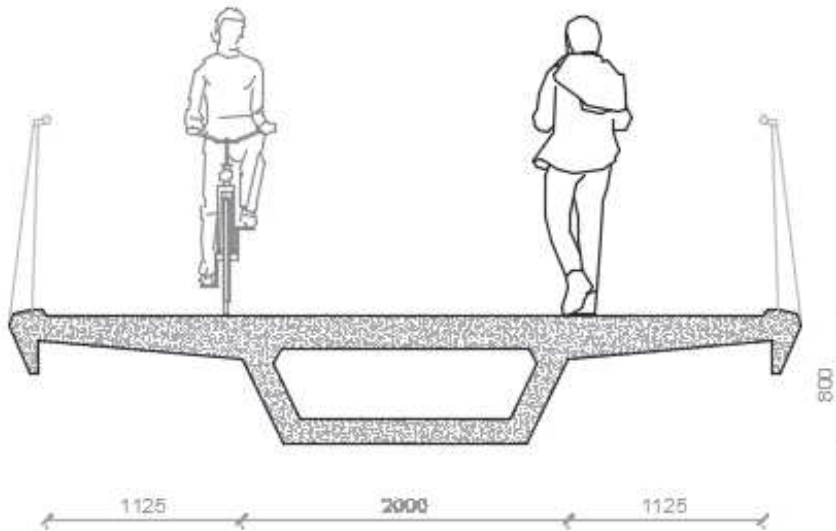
Solución B: Cajón central de hormigón. Cotas en mm
